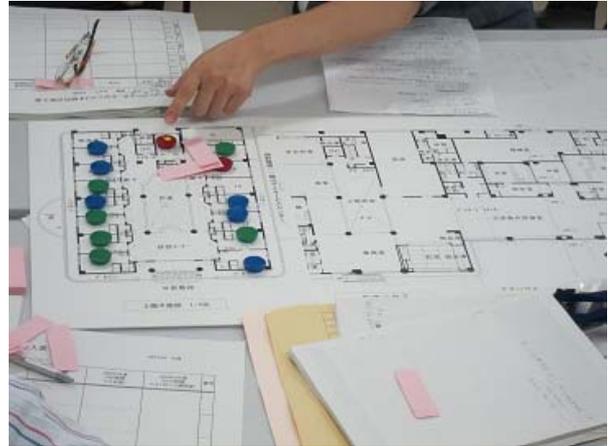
課題2の平面図、時間経過表、職員・住人として磁石を利用した配置状況
